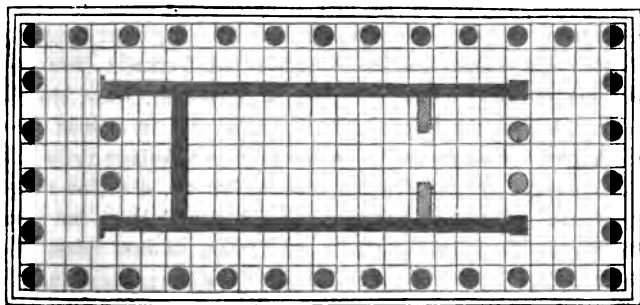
Grundriss des Theseustempels zu Athen.
